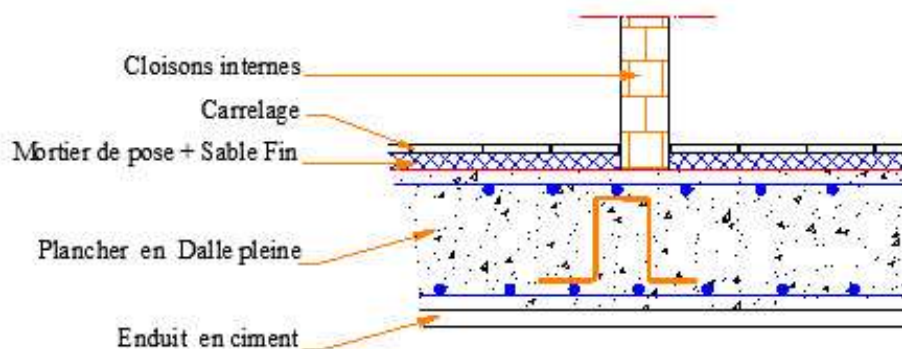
Coupe verticale du plancher étages courants (Dalle pleine)
